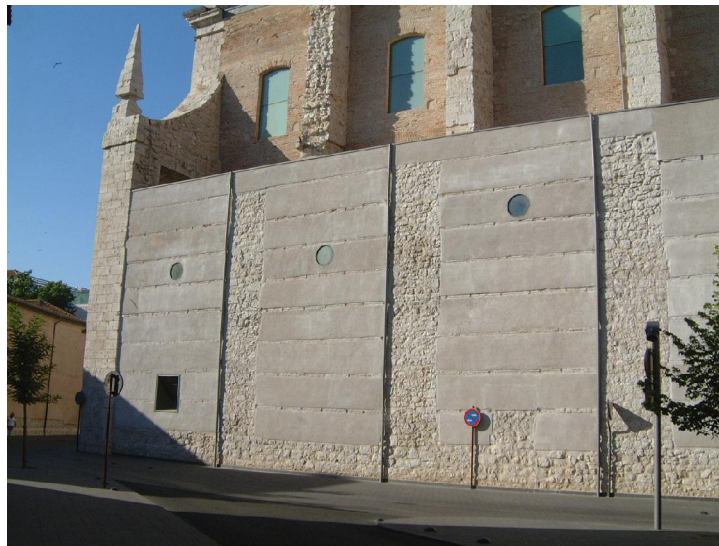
Lateral de la antigua iglesia de San Agustín restaurada para su utilización como Archivo Municipal de Valladolid. En la imagen se puede apreciar la construcción de esta fachada: zócalo de mampostería, machones de mampostería y tapias entre verdugadas de ladrillo revocados en color gris.
